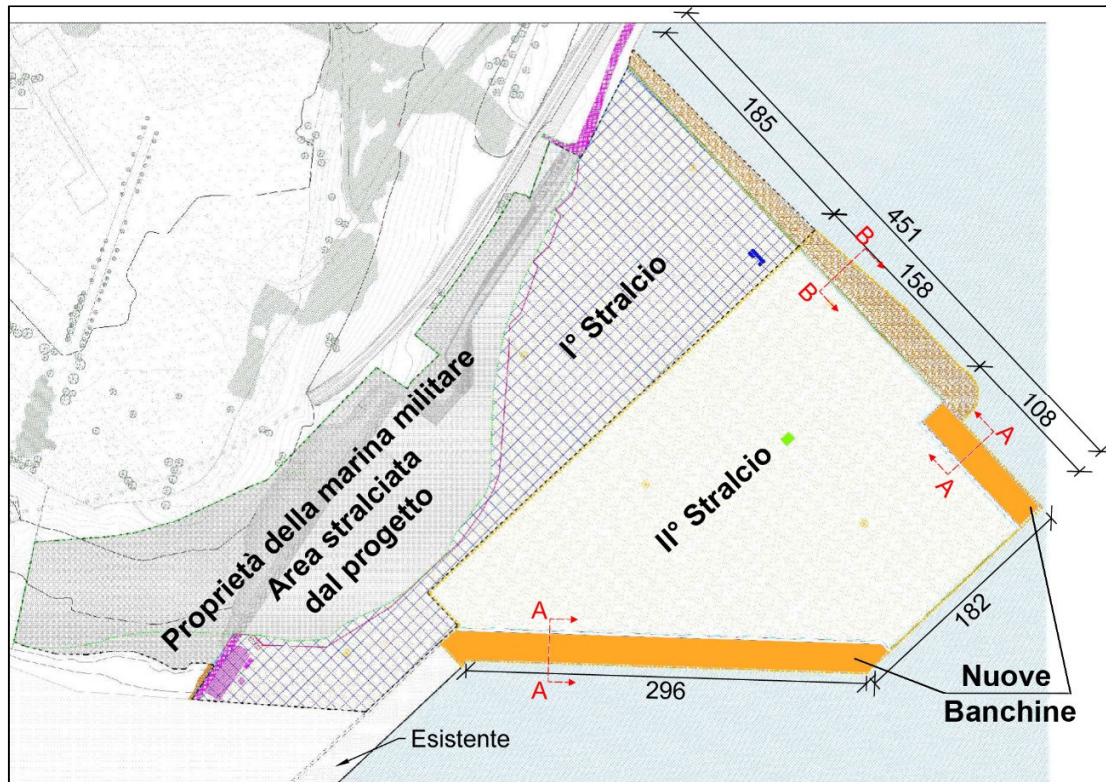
Planimetria piazzali progetto definitivo II stralcio
